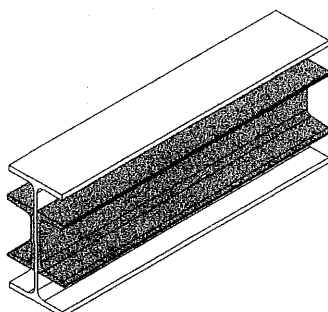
13. Refuerzos metálicos de vigas: refuerzos de secciones con perfiles H.
